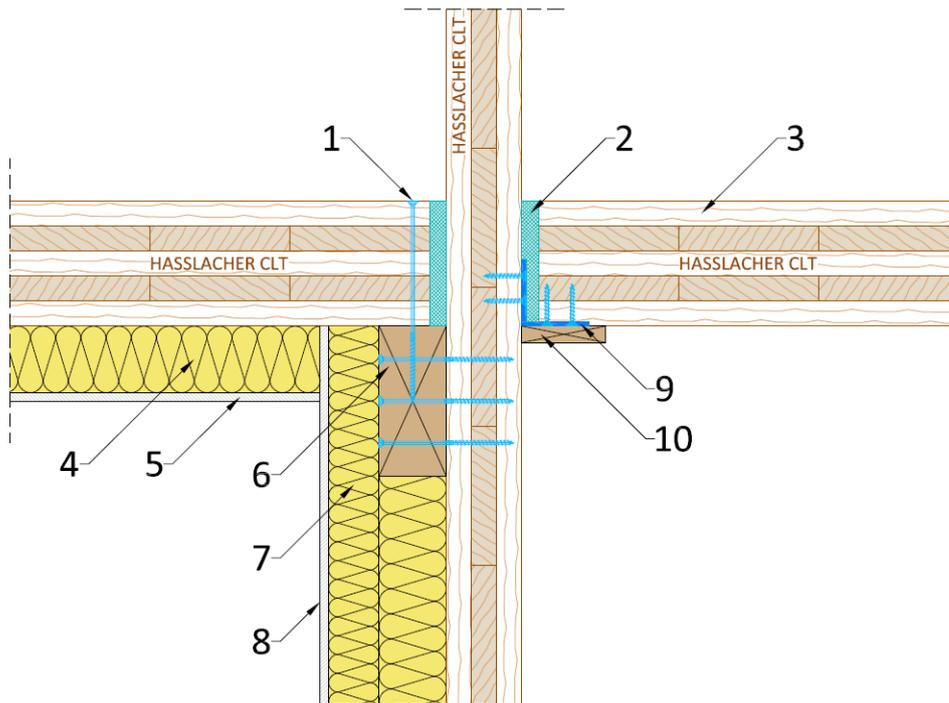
Coupe verticale : appui de panneau de plancher sur mur filant (à droite : cornière métallique, à gauche : lambourde)
